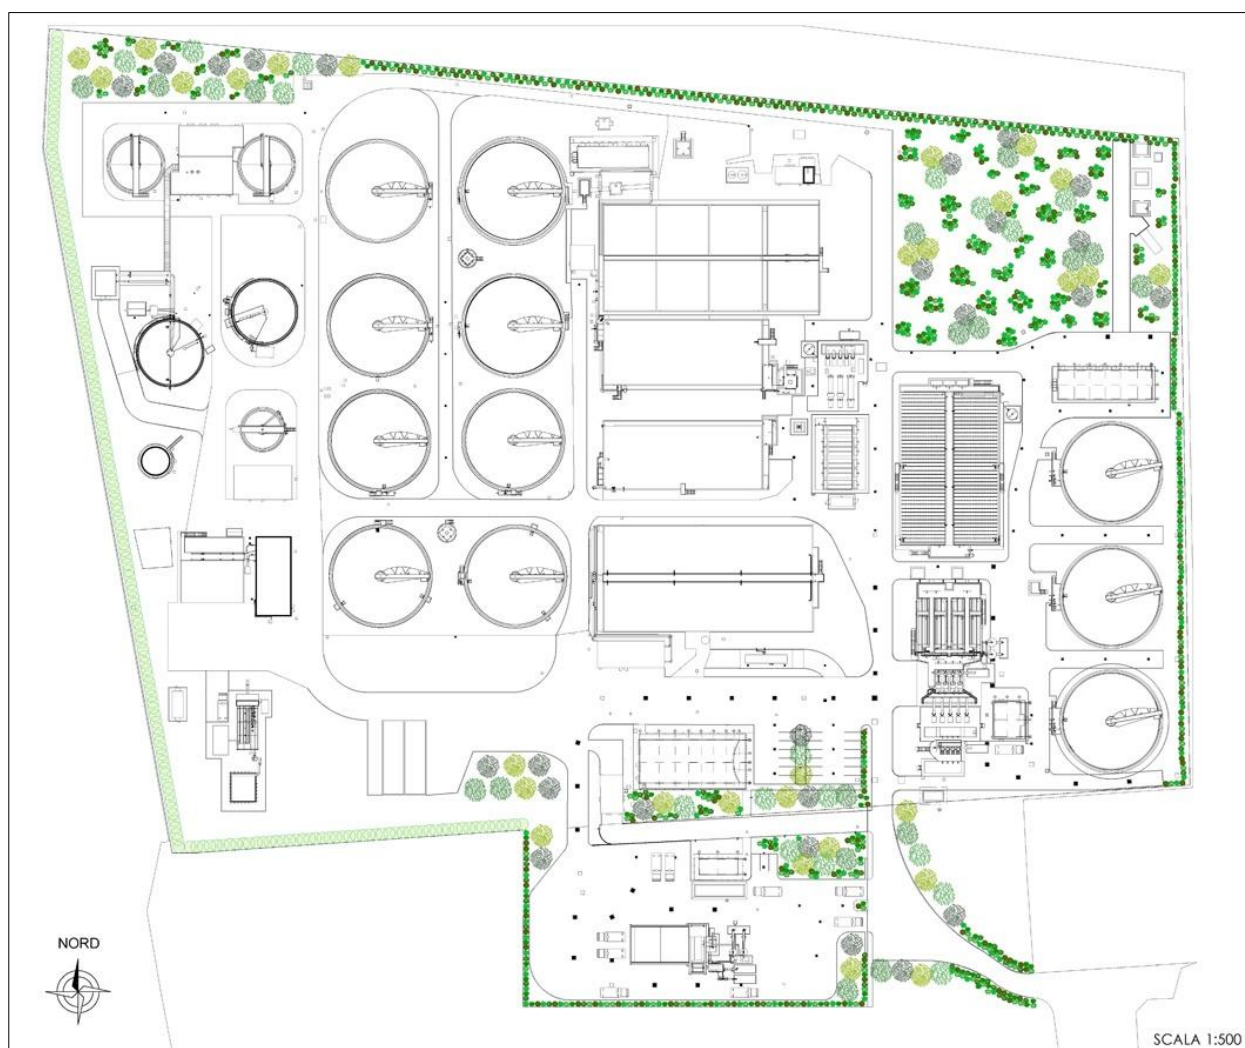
Planimetria di mitigazione a verde – Stato di progetto.
